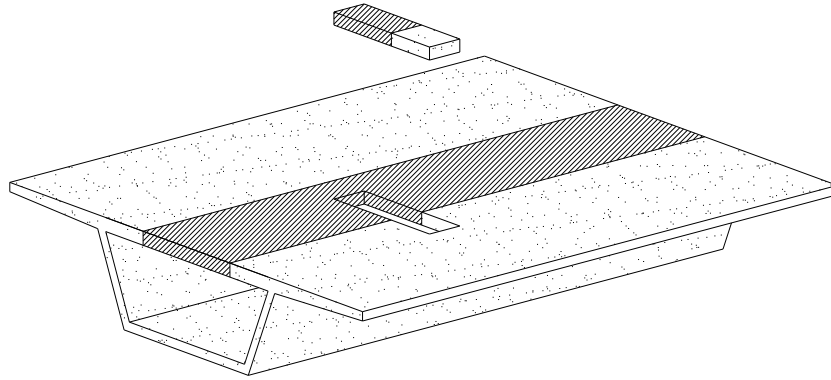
Ubicación de las losas en el tablero.
